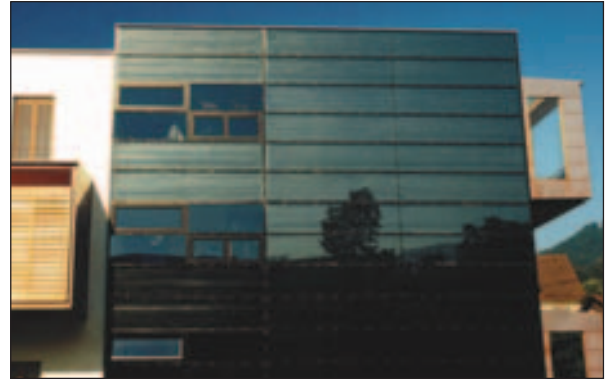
Fassadenkollektorfeld; Quelle: (8)
